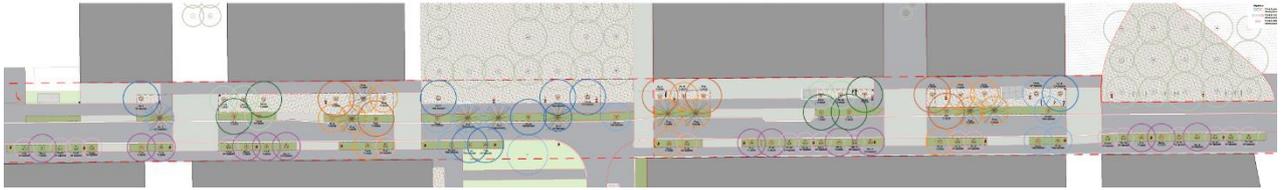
Figure 12 Plan de situation du paysagiste – Approches 2022
